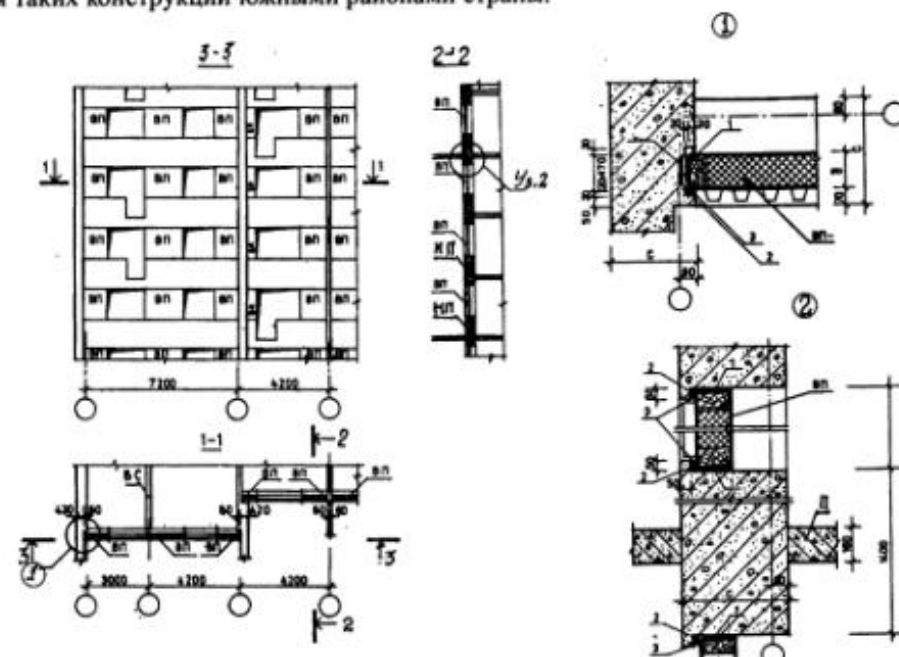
Монолитные наружные стены с бетонными междуоконными вставками: ВП - вставка панельная из небетонных материалов; МП - монолитный легобетонный пояс наружной стены; ВС - монолитная внутренняя стена; П - перекрытие; 1 - конопатка; 2 - упругая прокладка; 3 - герметик; 4 - закладная деталь
